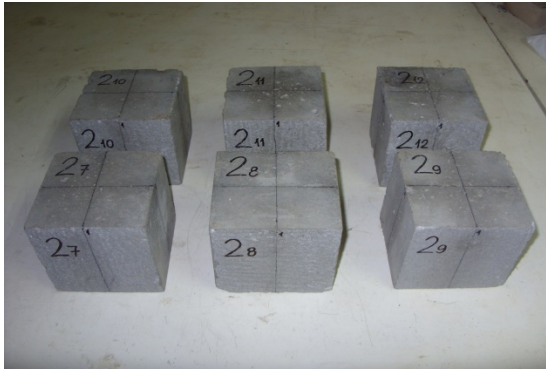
Загальний вигляд зразків, що виготовлялись в формах
